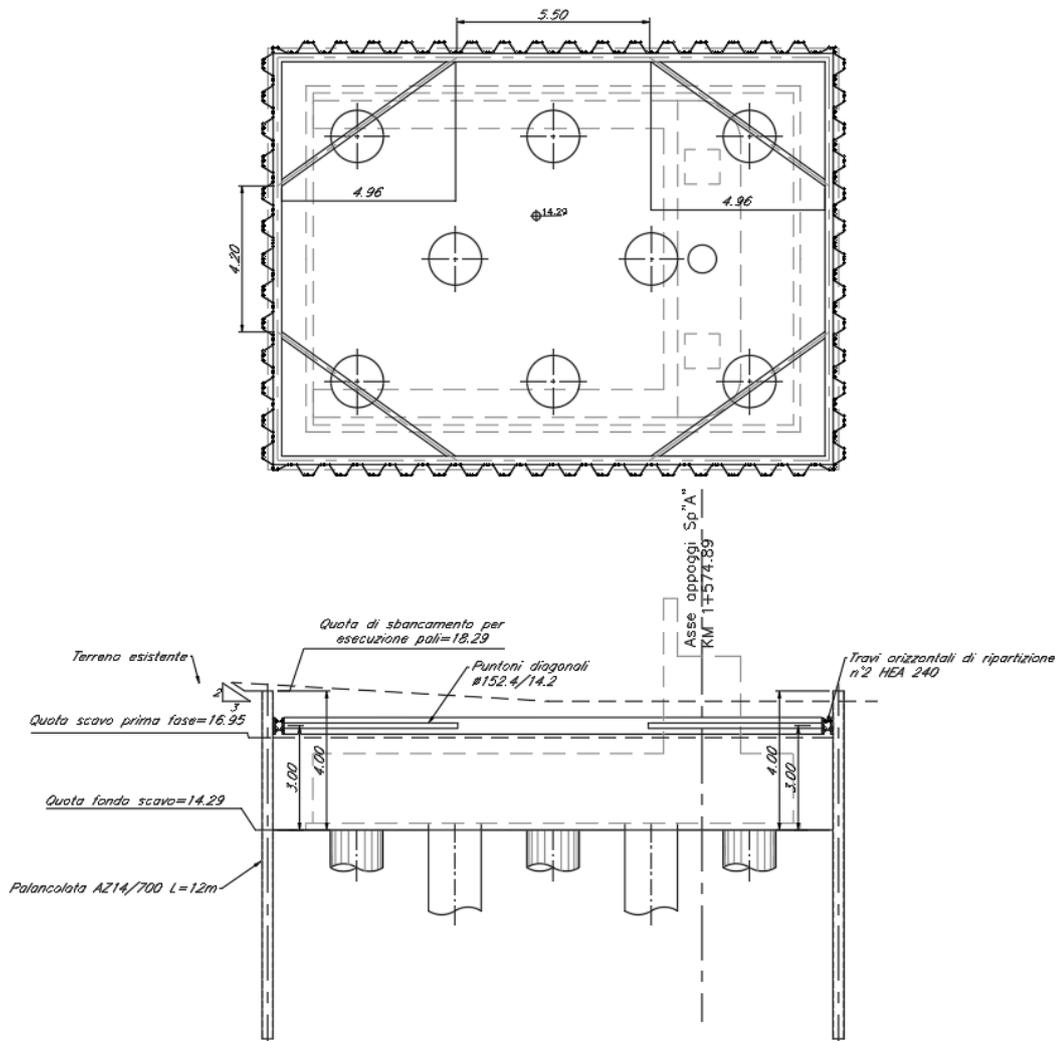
Pianta e Sezione Opere Provvisionali Spalla A
